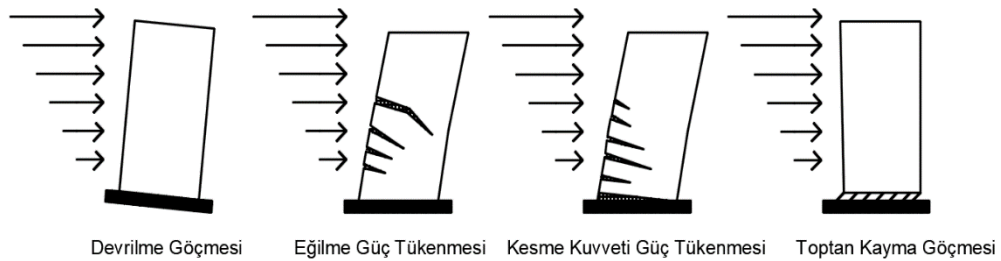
Yatay yük etkisi altında betonarme perde davranışı
